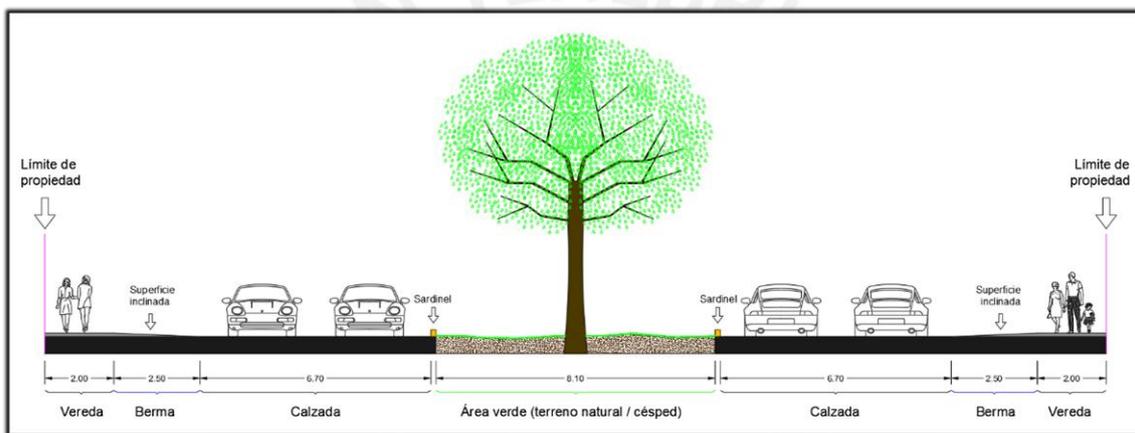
Vista en elevación de la sección típica de la Av. Mariscal Castilla. Fuente: elaboración propia.
